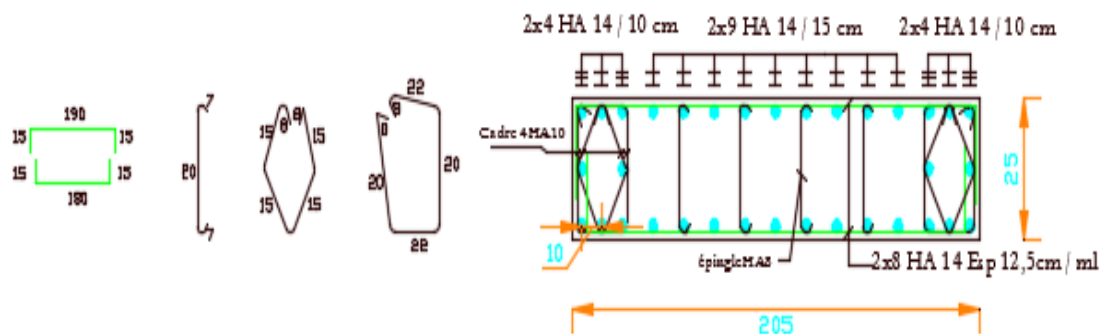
coupe transversale de ferrailage de voile longitudinale VL1
